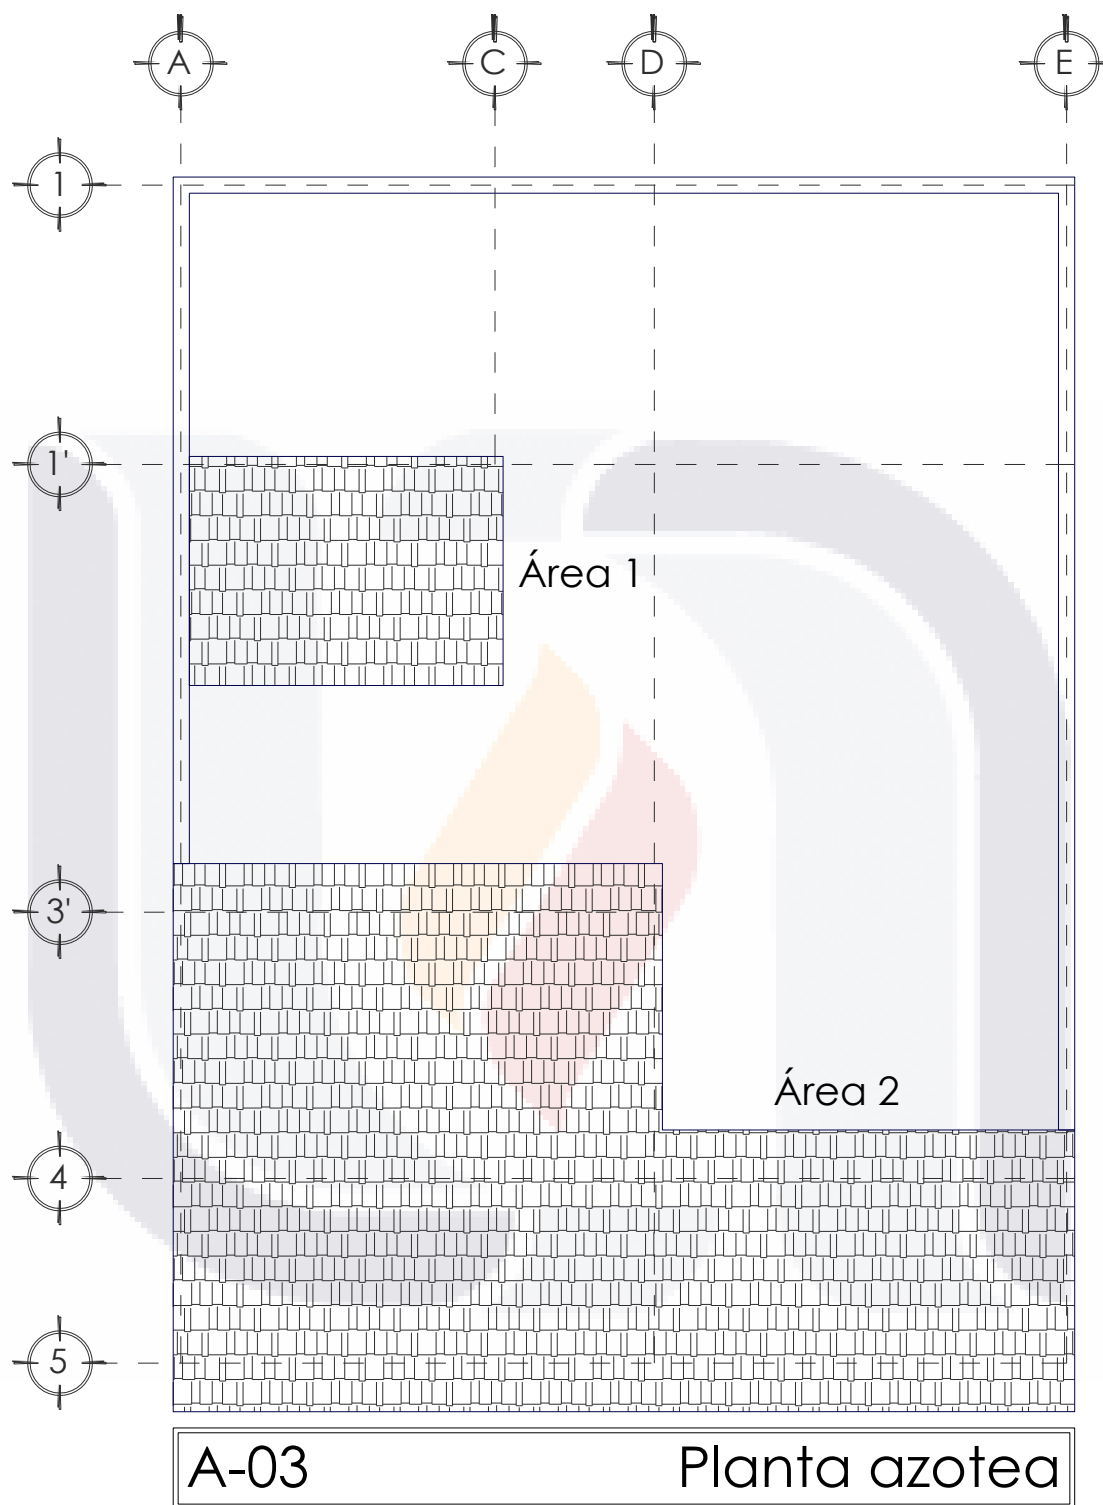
Plano arquitectónico de vivienda. Planta de azotea
